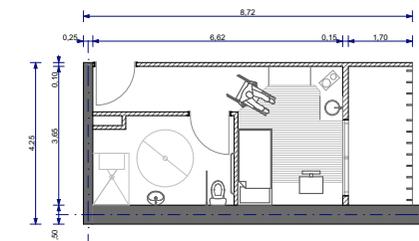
Planta tipologías habitaciones. Fuente: Elaboración propia
